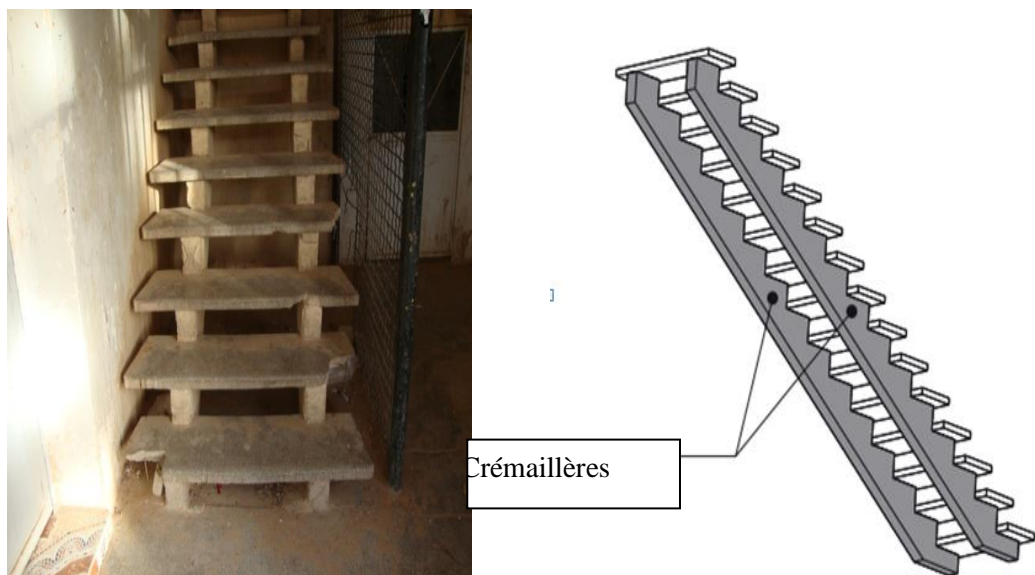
Escaliers préfabriqués avec crémaillères en béton
